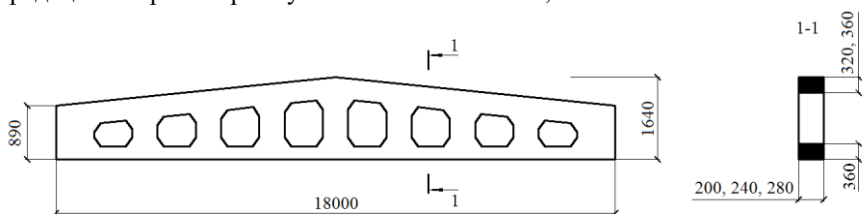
Двускатная решетчатая балка покрытия прямоугольного сечения пролетом 18 м
